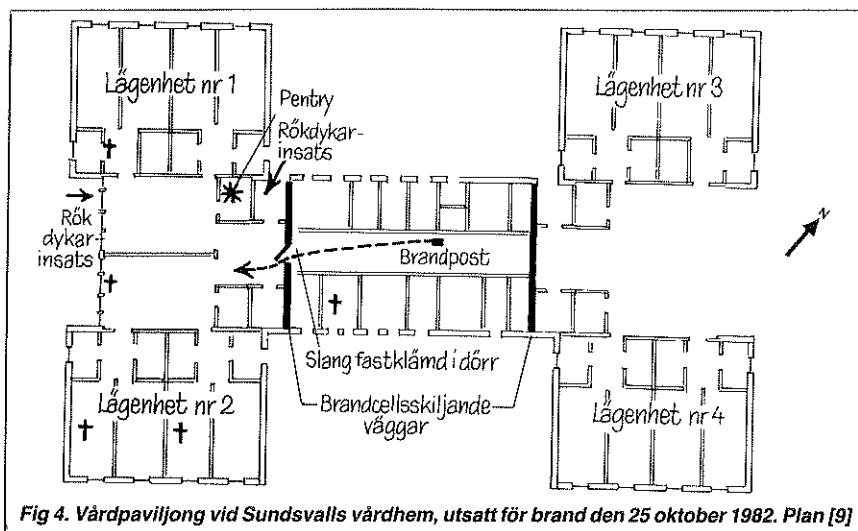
Vårdpaviljong vid Sundsvalls vårdhem, utsatt för brand den 25 oktober 1982. Plan [9]
